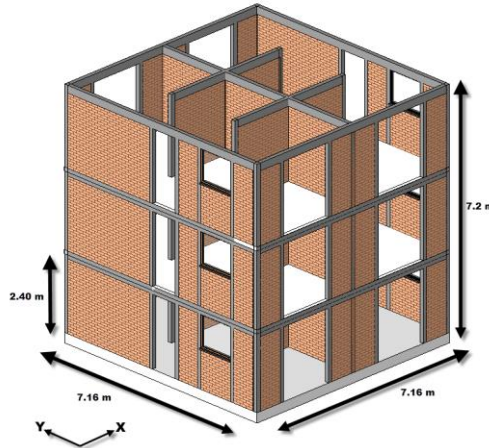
Vista en 3D del edificio de mampostería (Arias, 2005)
